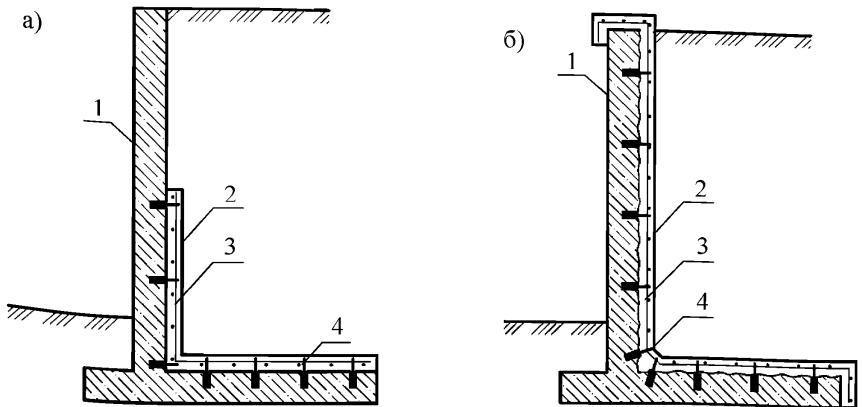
Нарращивание железобетонной обоймы в растянутой зоне:
